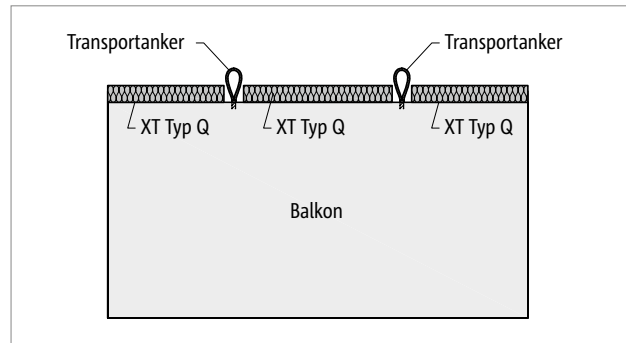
Schöck Isokorb® XT Typ Q: Vollfertigteilbalkon mit Transportanker; Dämmzwischenstück XT Typ Z kann bauseitig eingelegt werden
